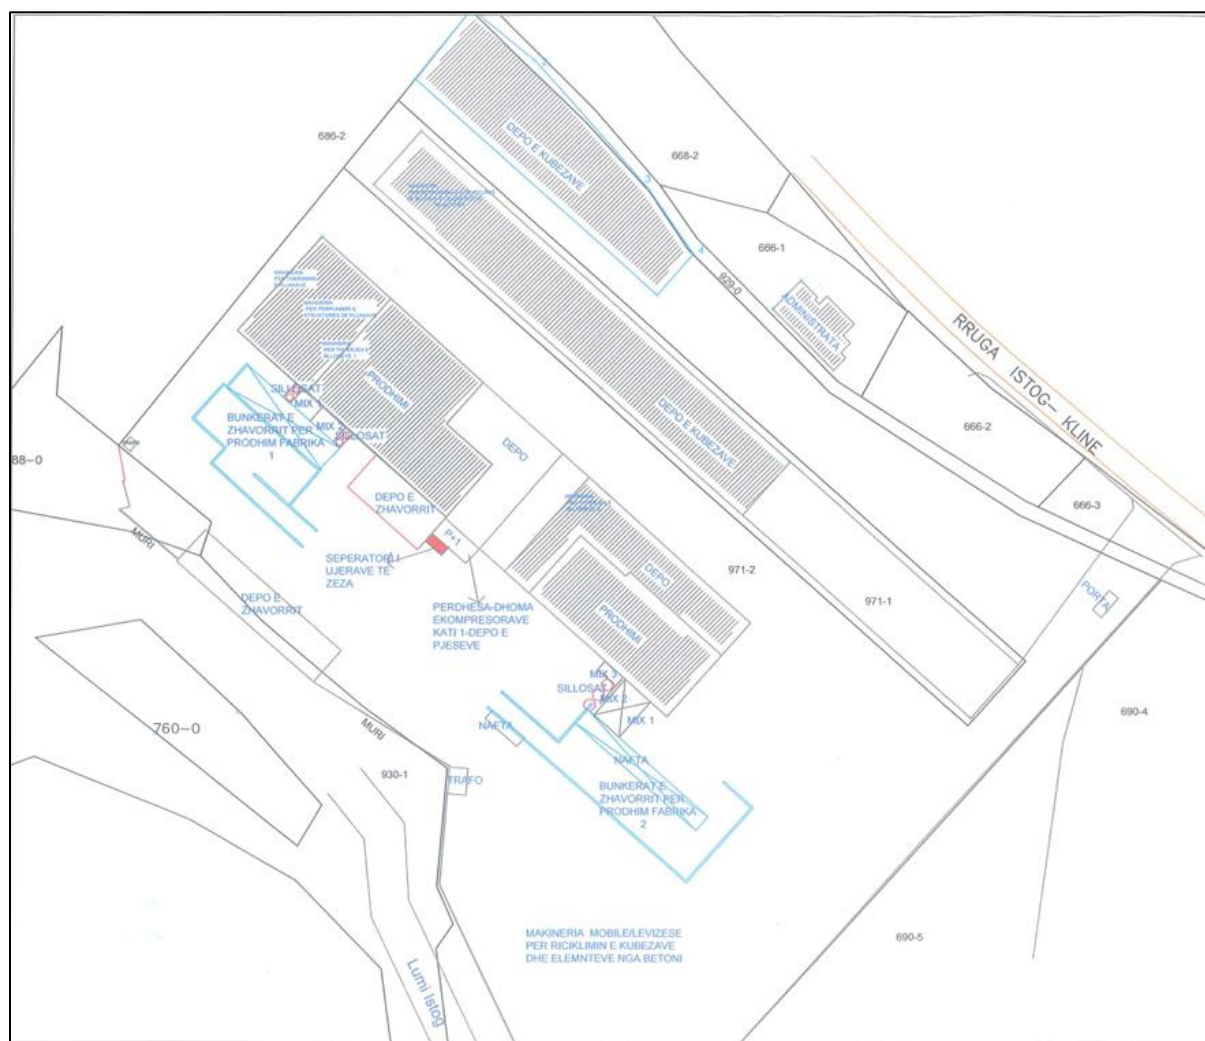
Plan situacioni i shtrirjes së Impiantit.
